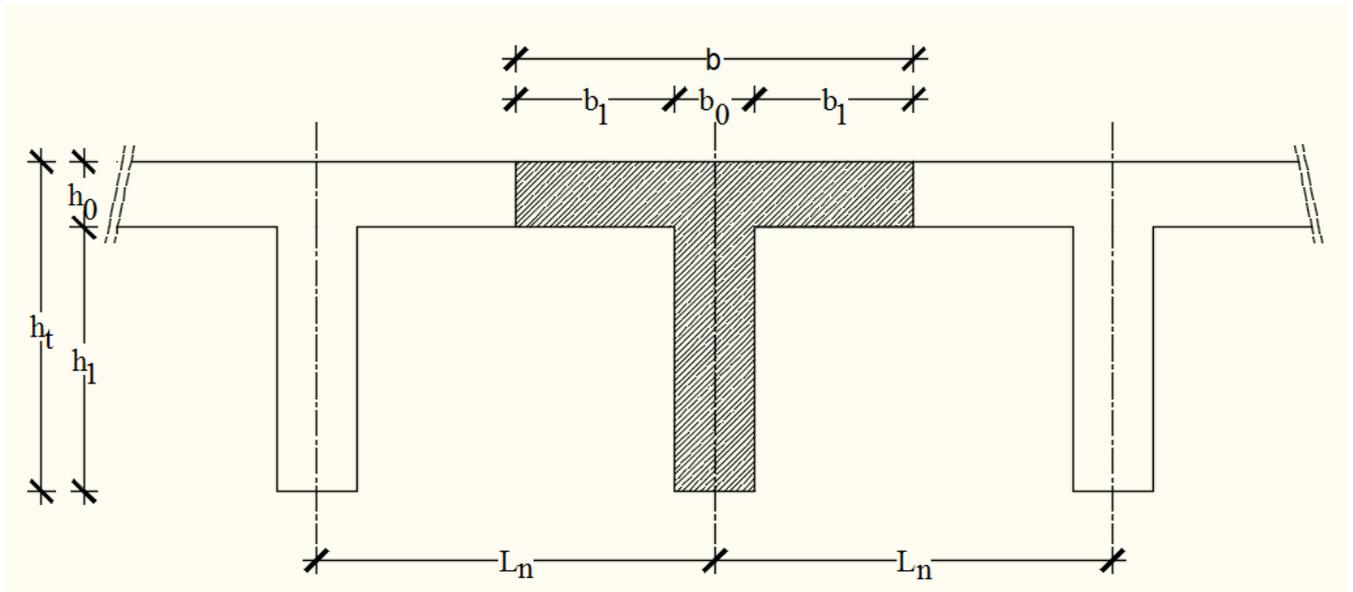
coupe transversale d'un plancher à corps creux.
